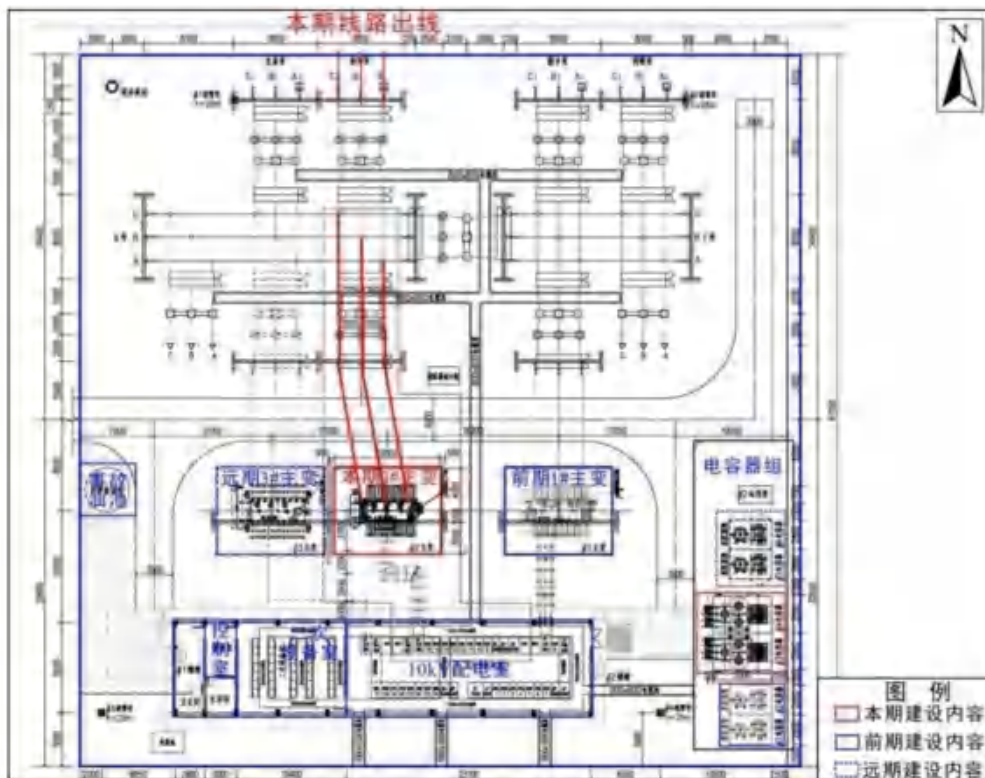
河南新乡辉县姚屯 110 千伏变电站平面布置示意图
